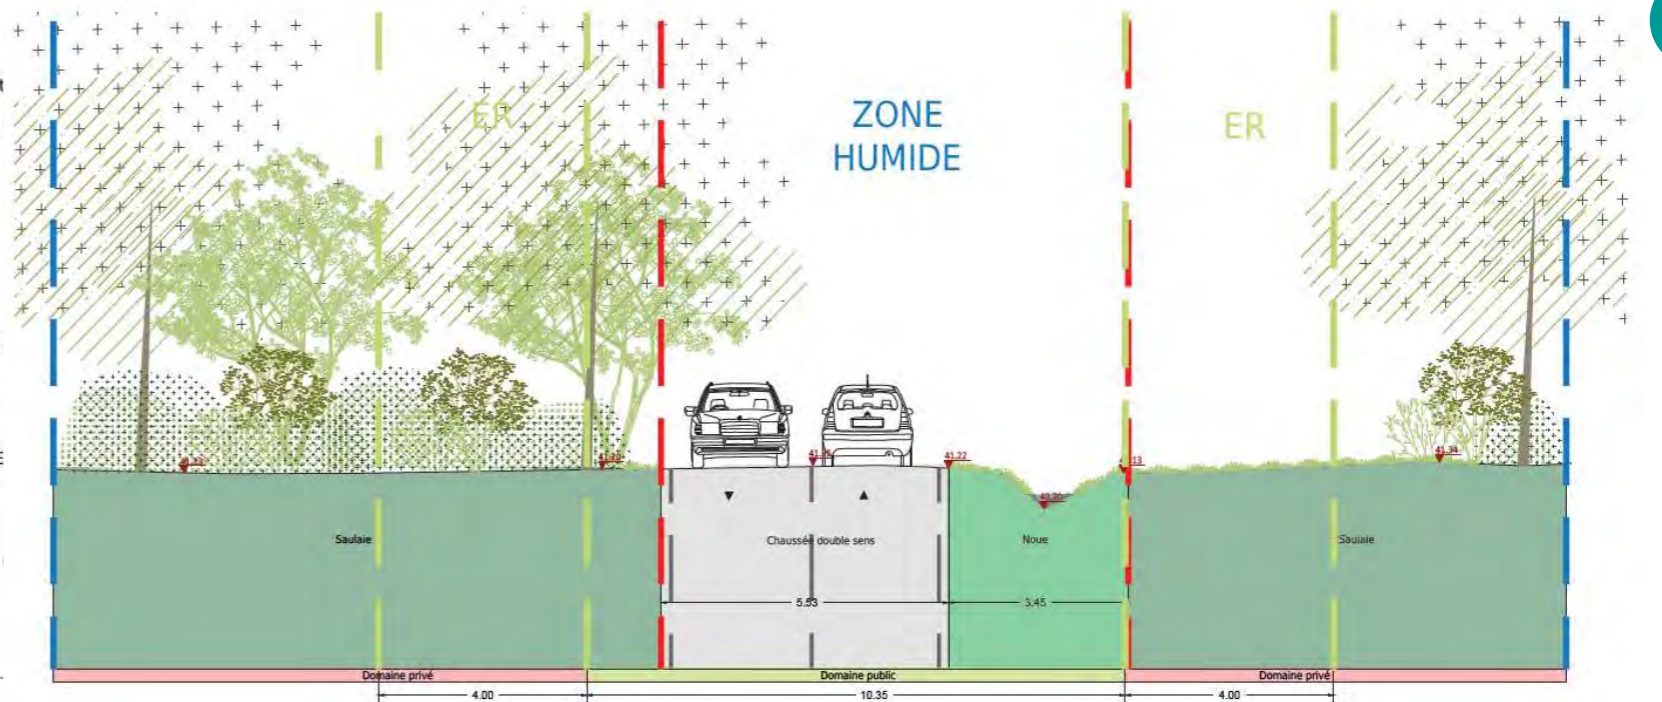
Avenue de Mazeau – Plan projet et coupes
